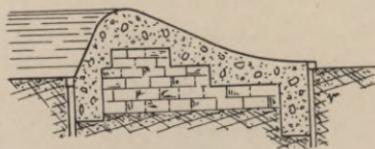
Wehr aus Beton und Mauerwerk. 1 : 100.
